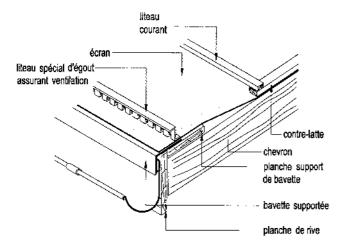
Raccordement à l'égout avec liteau spécial assurant la ventilation
